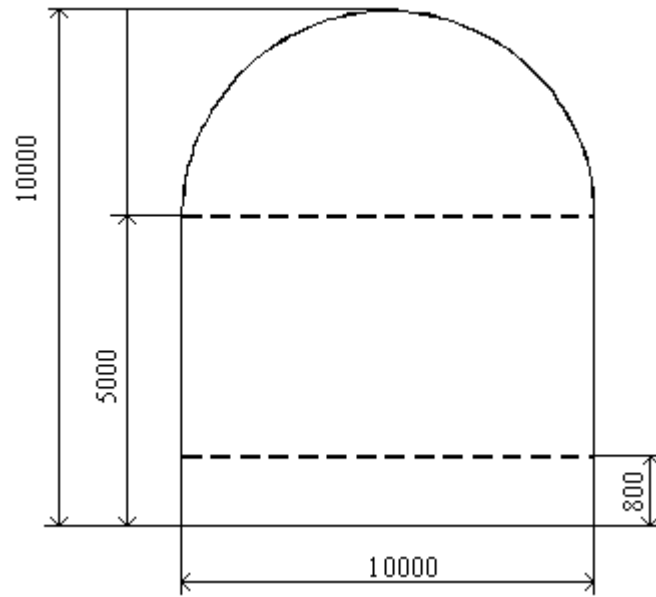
Поперечный разрез помещения со сводом к задаче 1.2.11
